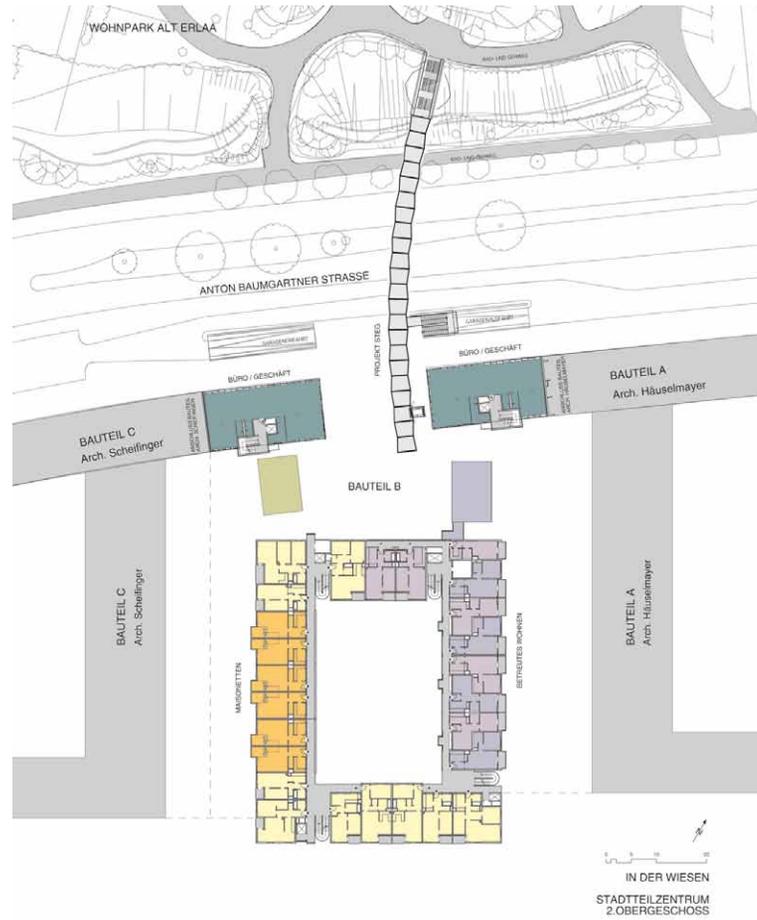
/ Plano plantas 3-5, viviendas para ancianos en violeta.
